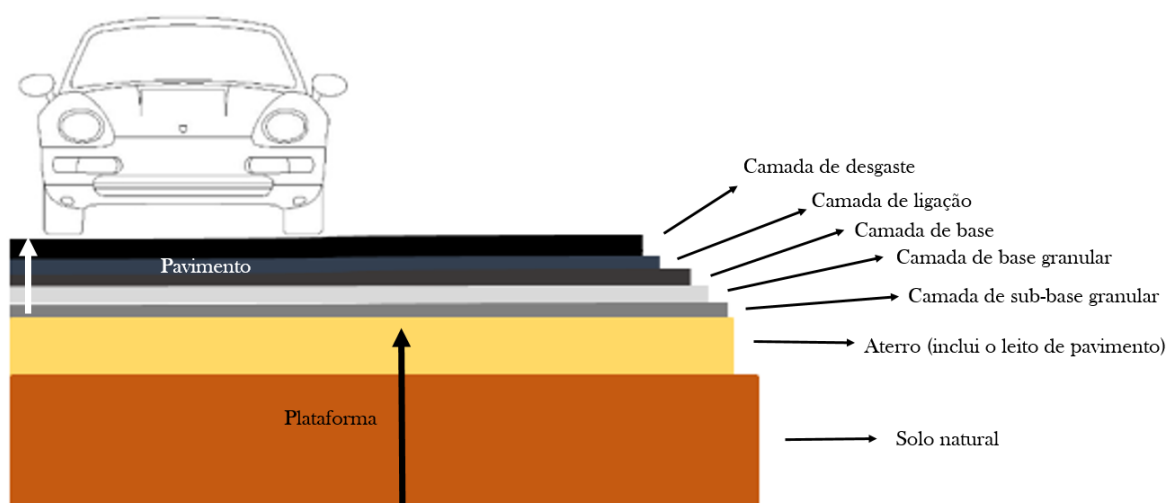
Estrutura geral do pavimento rodoviário - Tipo de camadas da estrada. Adaptado do Instituto de Infraestruturas rodoviárias. Fonte: Estradas de Portugal, 2009 – Pavimentação.
